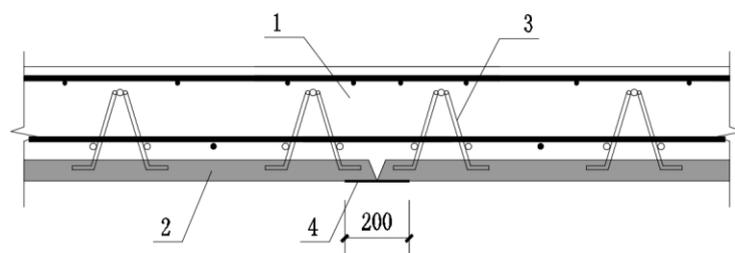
钢筋桁架保温楼承板侧接缝构造示意
